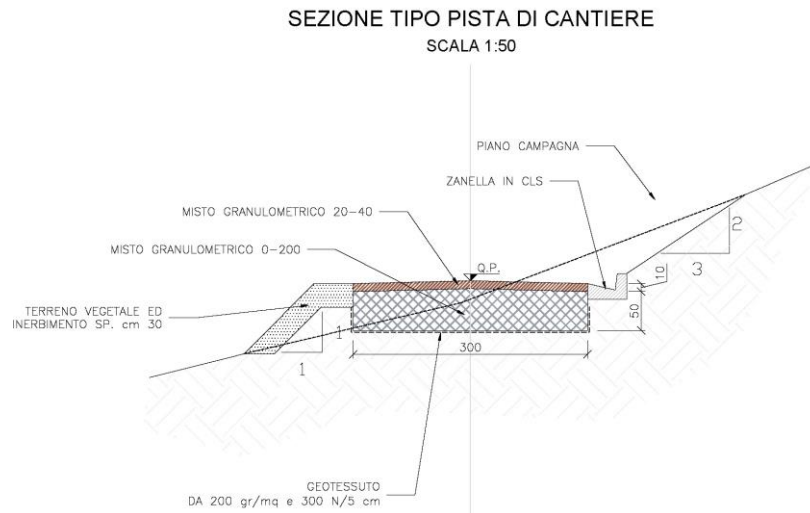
Sezione tipo piste di cantiere nuova realizzazione.
